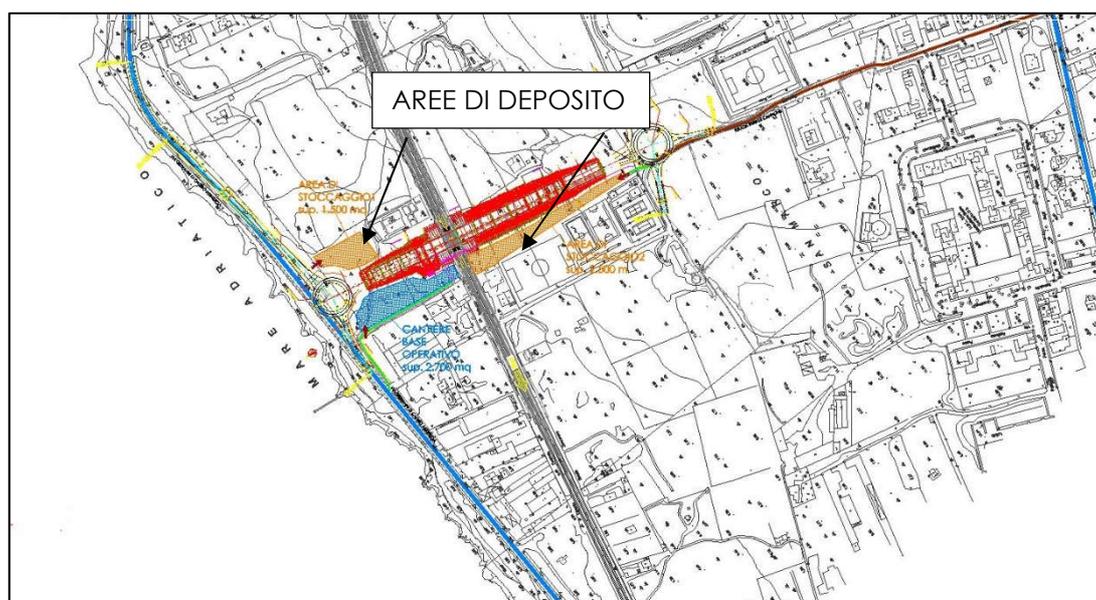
Stralcio planimetrico con indicazione delle aree di stoccaggio temporaneo
